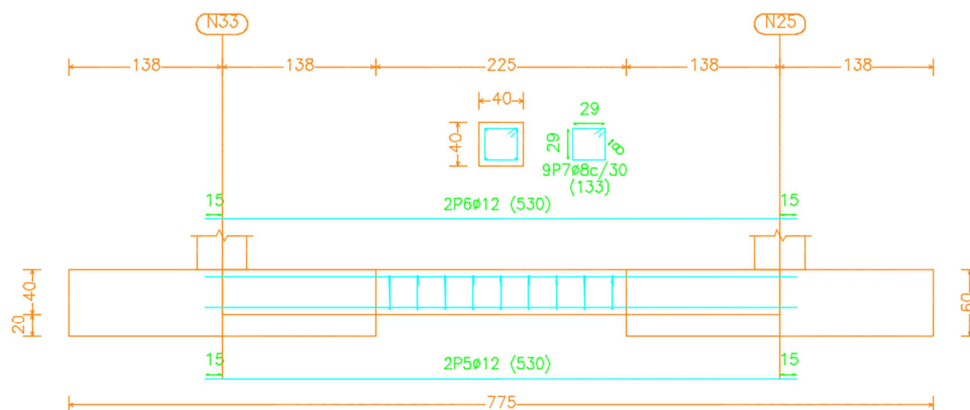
Detalle de la cimentación de los pilares de pórticos intermedios
